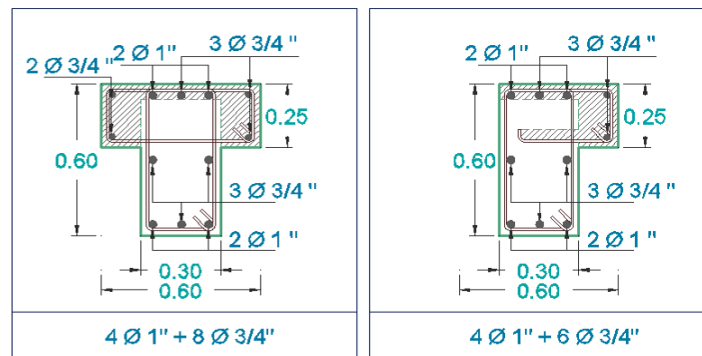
REFORZAMIENTO DE LAS COLUMNAS DEL PABELLÓN 1C.
